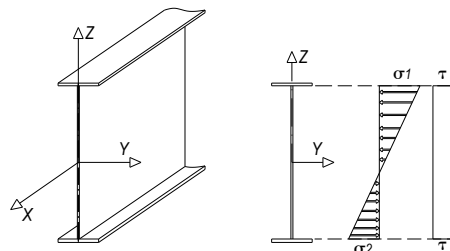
Alma submetida à tensões normais longitudinais (σ) e tensões de cisalhamento (τ).
